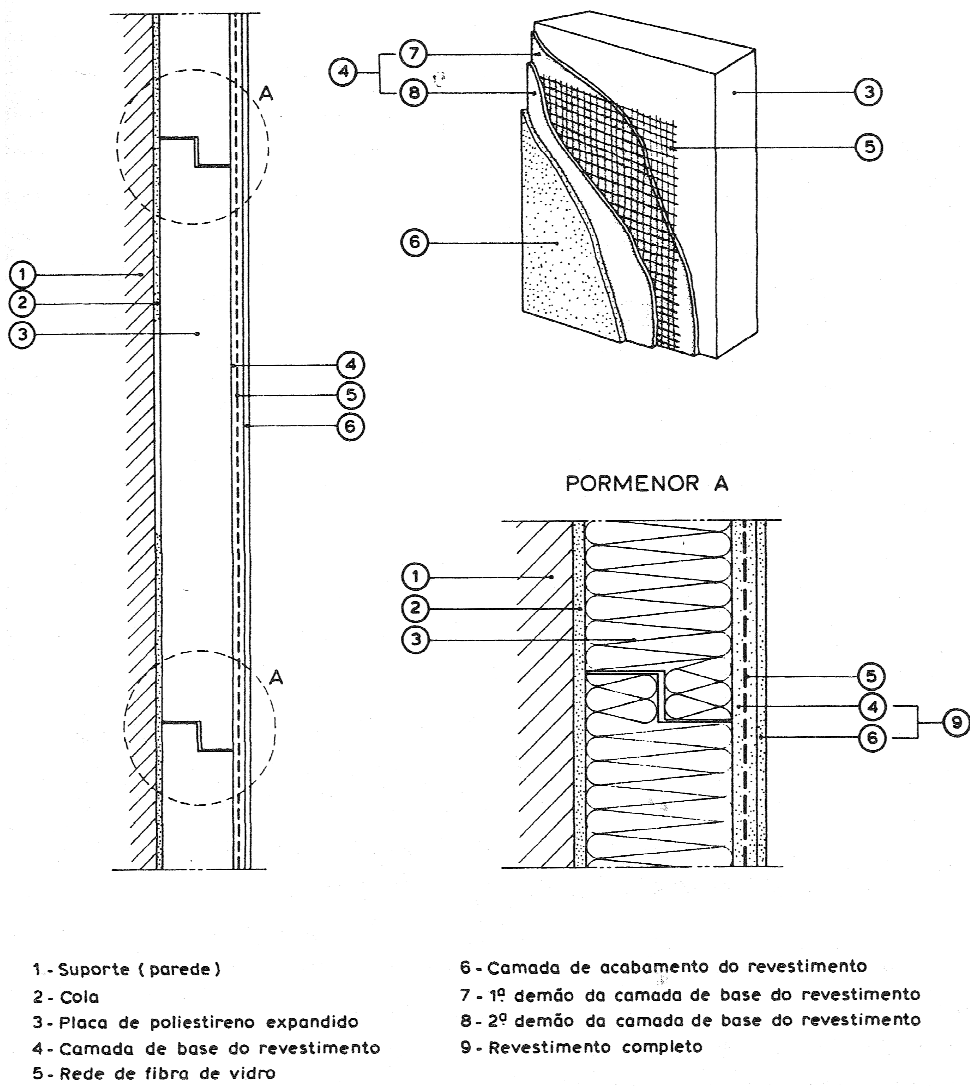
Sistema de isolamento térmico pelo exterior de fachadas – sistema ETICS
